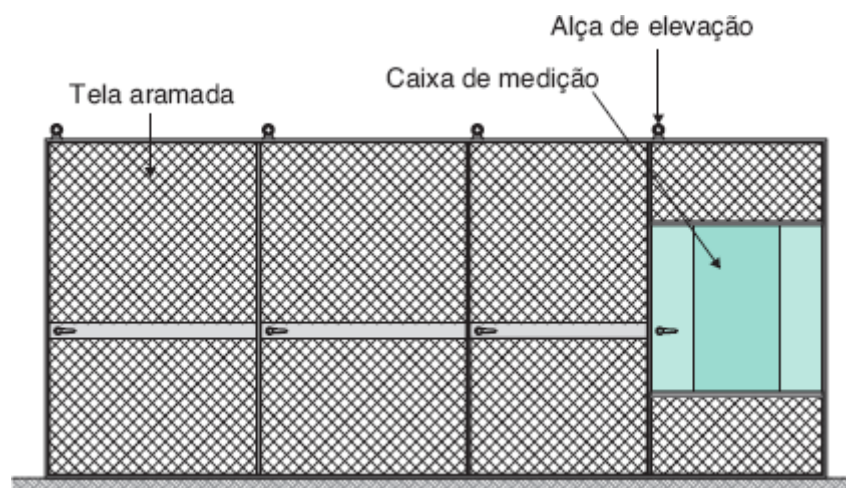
Vista frontal externa de uma subestação modular metálica com tela aramada.
